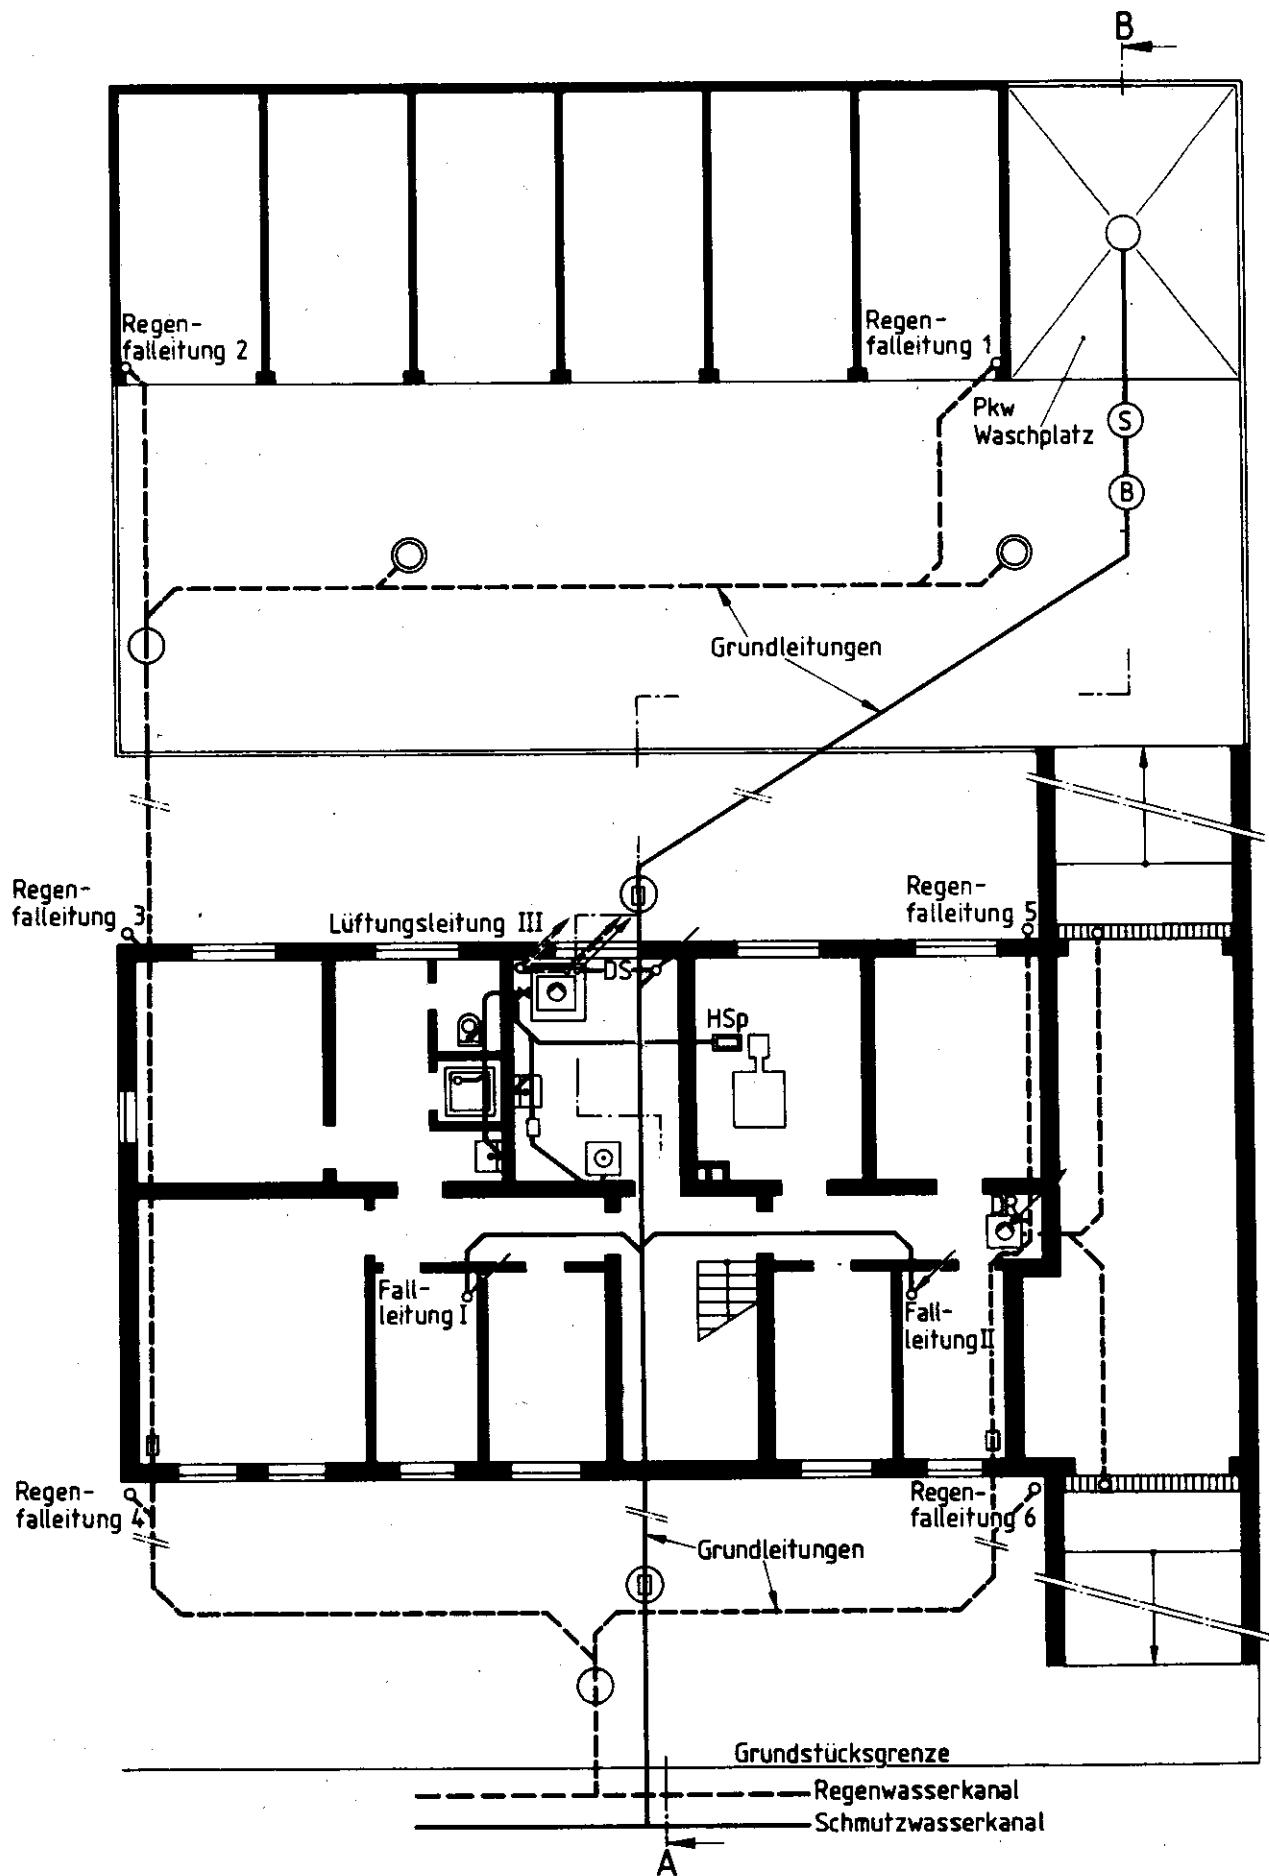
Kellergeschoß mit Grund- und Sammelleitungen sowie Abwasserhebeanlagen beim Trennverfahren
